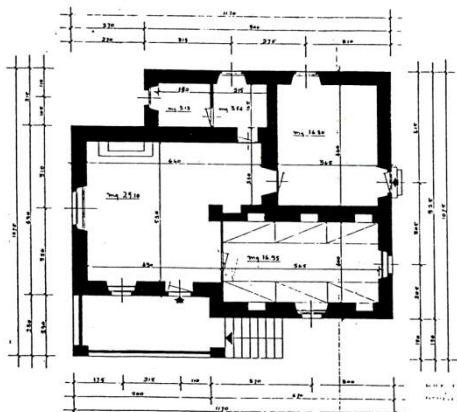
PIANTE PIANO TERRA ESISTENTE
